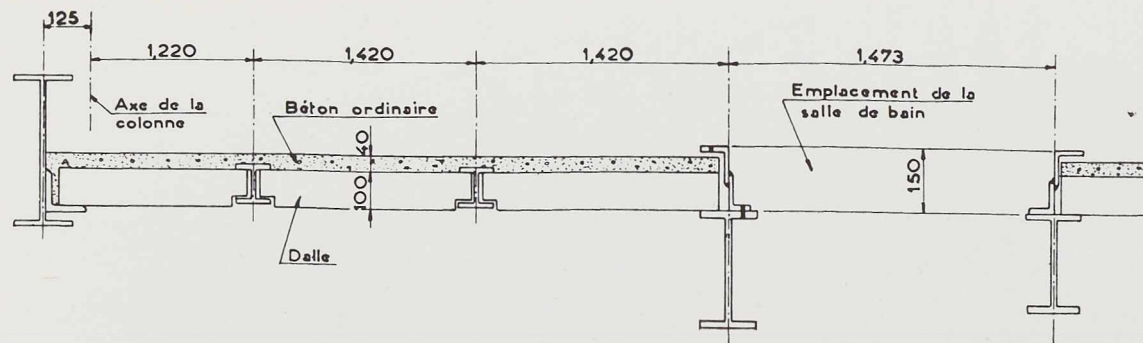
Pose des dalles de béton et alvéole pour salle de bain.
